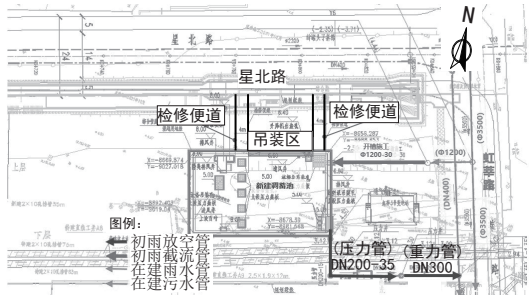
九星排水泵站初雨调蓄池(星北路)总平面布置图
